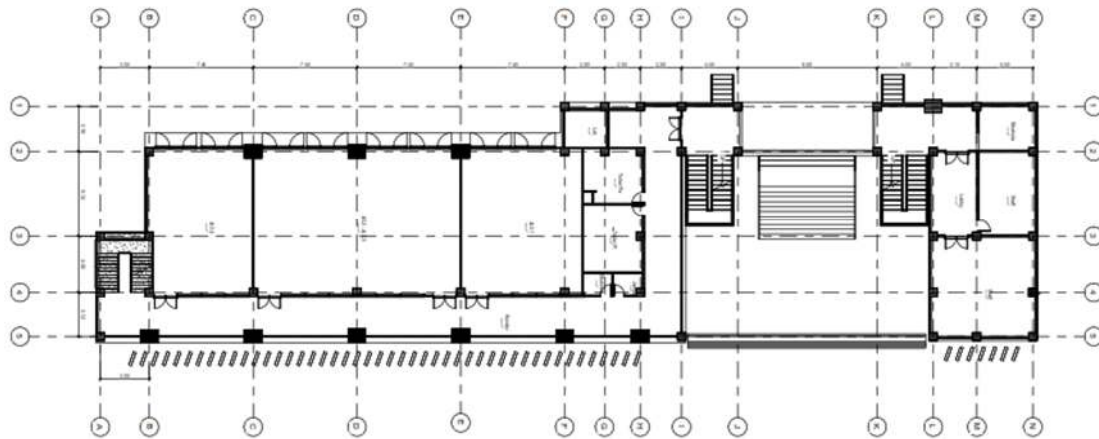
3 Denah Lantai 2 Bangunan Gedung A Vokasi UNDIP
